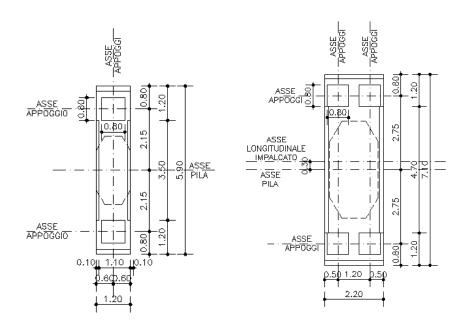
Sezioni trasversali pila tipo e pile P10/P11
